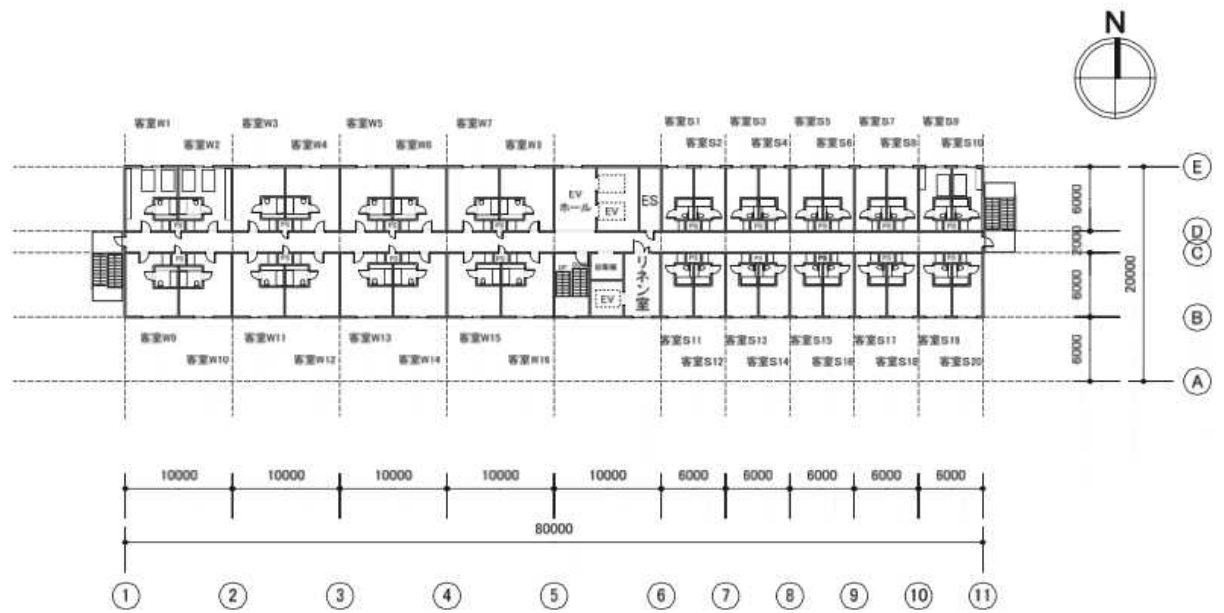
モデル建物（ビジネスホテル等） 2～4階平面図
